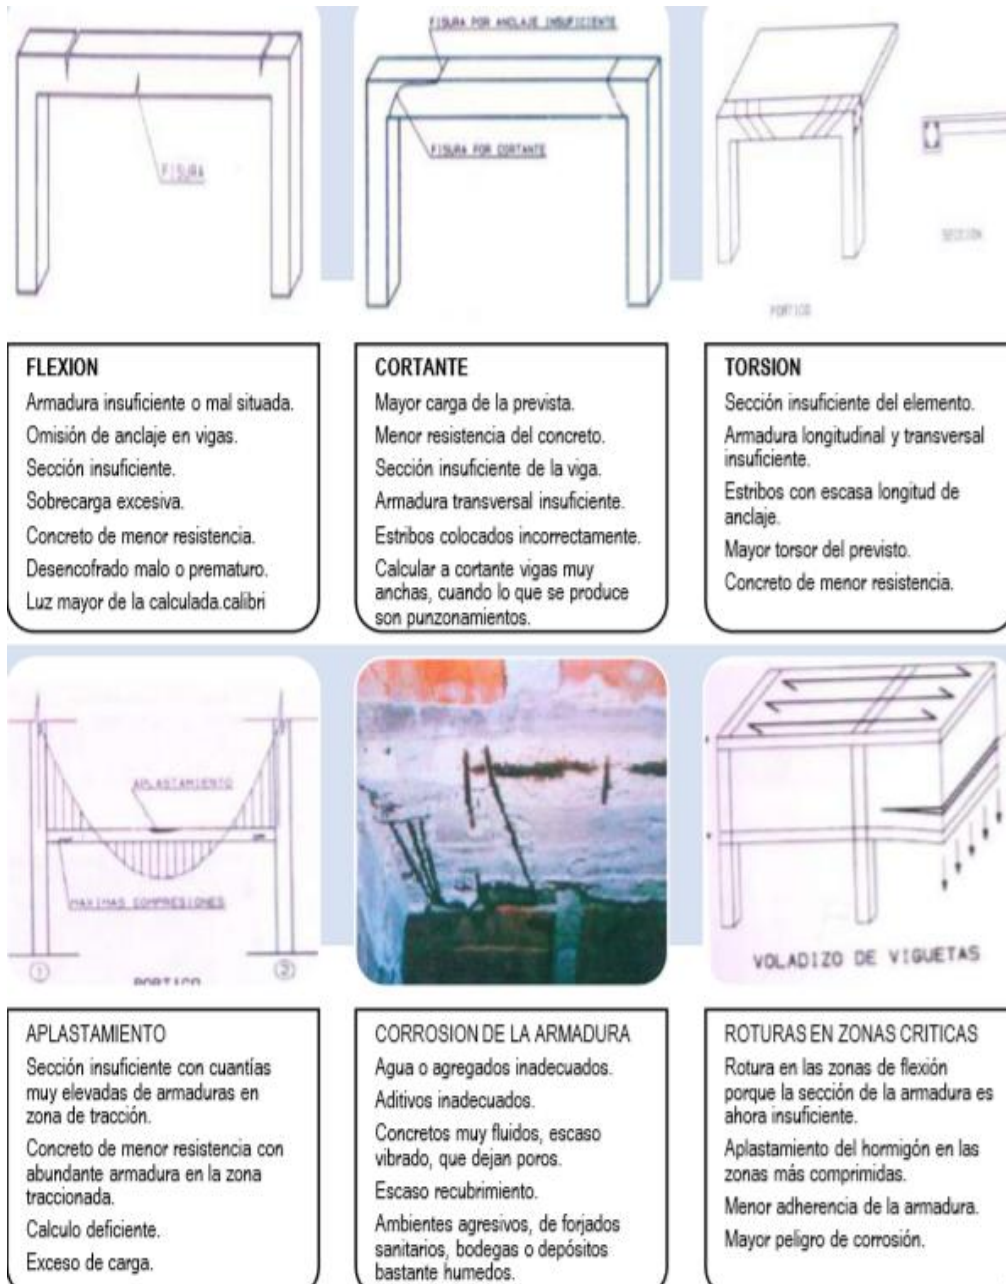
Fallas en vigas, Fuente: Modificado de (Torrealva, D., 2007)
